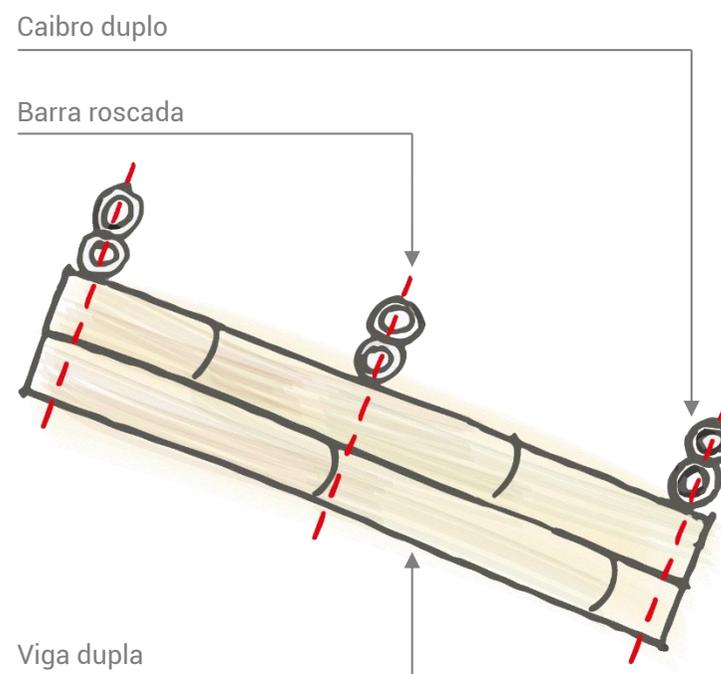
Croqui da conexão entre o caibro e o vigamento da cobertura.
